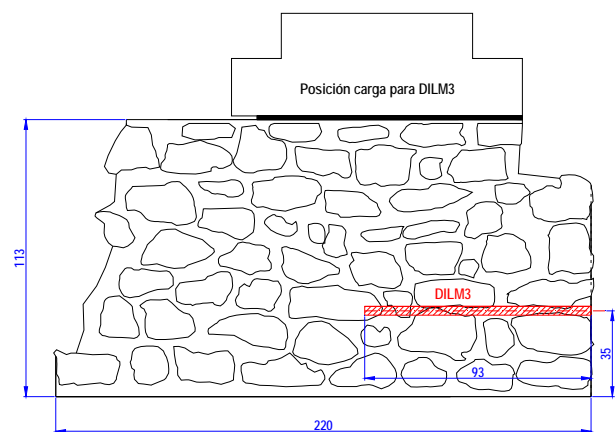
Ubicación de la sonda presurométrica dentro del alzado del muro de mampostería (DILM3).
